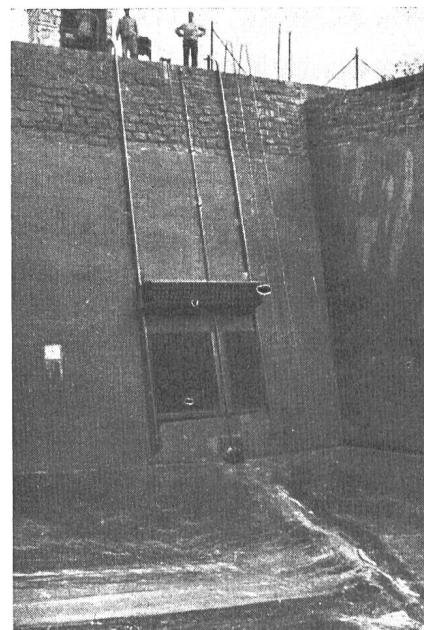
EW Massagno. Fassung der Druckleitung mit Rechen und Rechenreinigungsanlage, darunter Leerlauf und Spülleitung.
